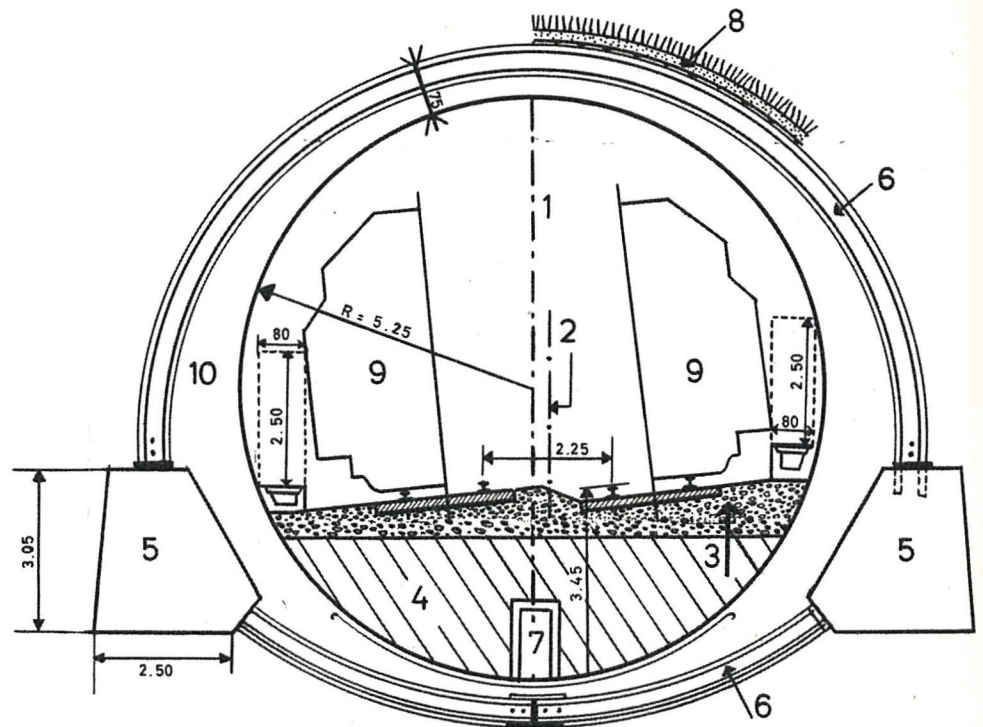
1. Axe du tunnel ; 2. Axe de l'entre-voie ; 3. Ballast ; 4. Matériaux perméables ; 5. Galeries de piédroits ; 6. Poutres HE 340 B (cintres) ; 7. Caniveau central ; 8. Injection de ciment entre la roche et les plaques de blindage ; 9. Gabarit au droit des voies en courbe ; 10. Plaques de blindage.
